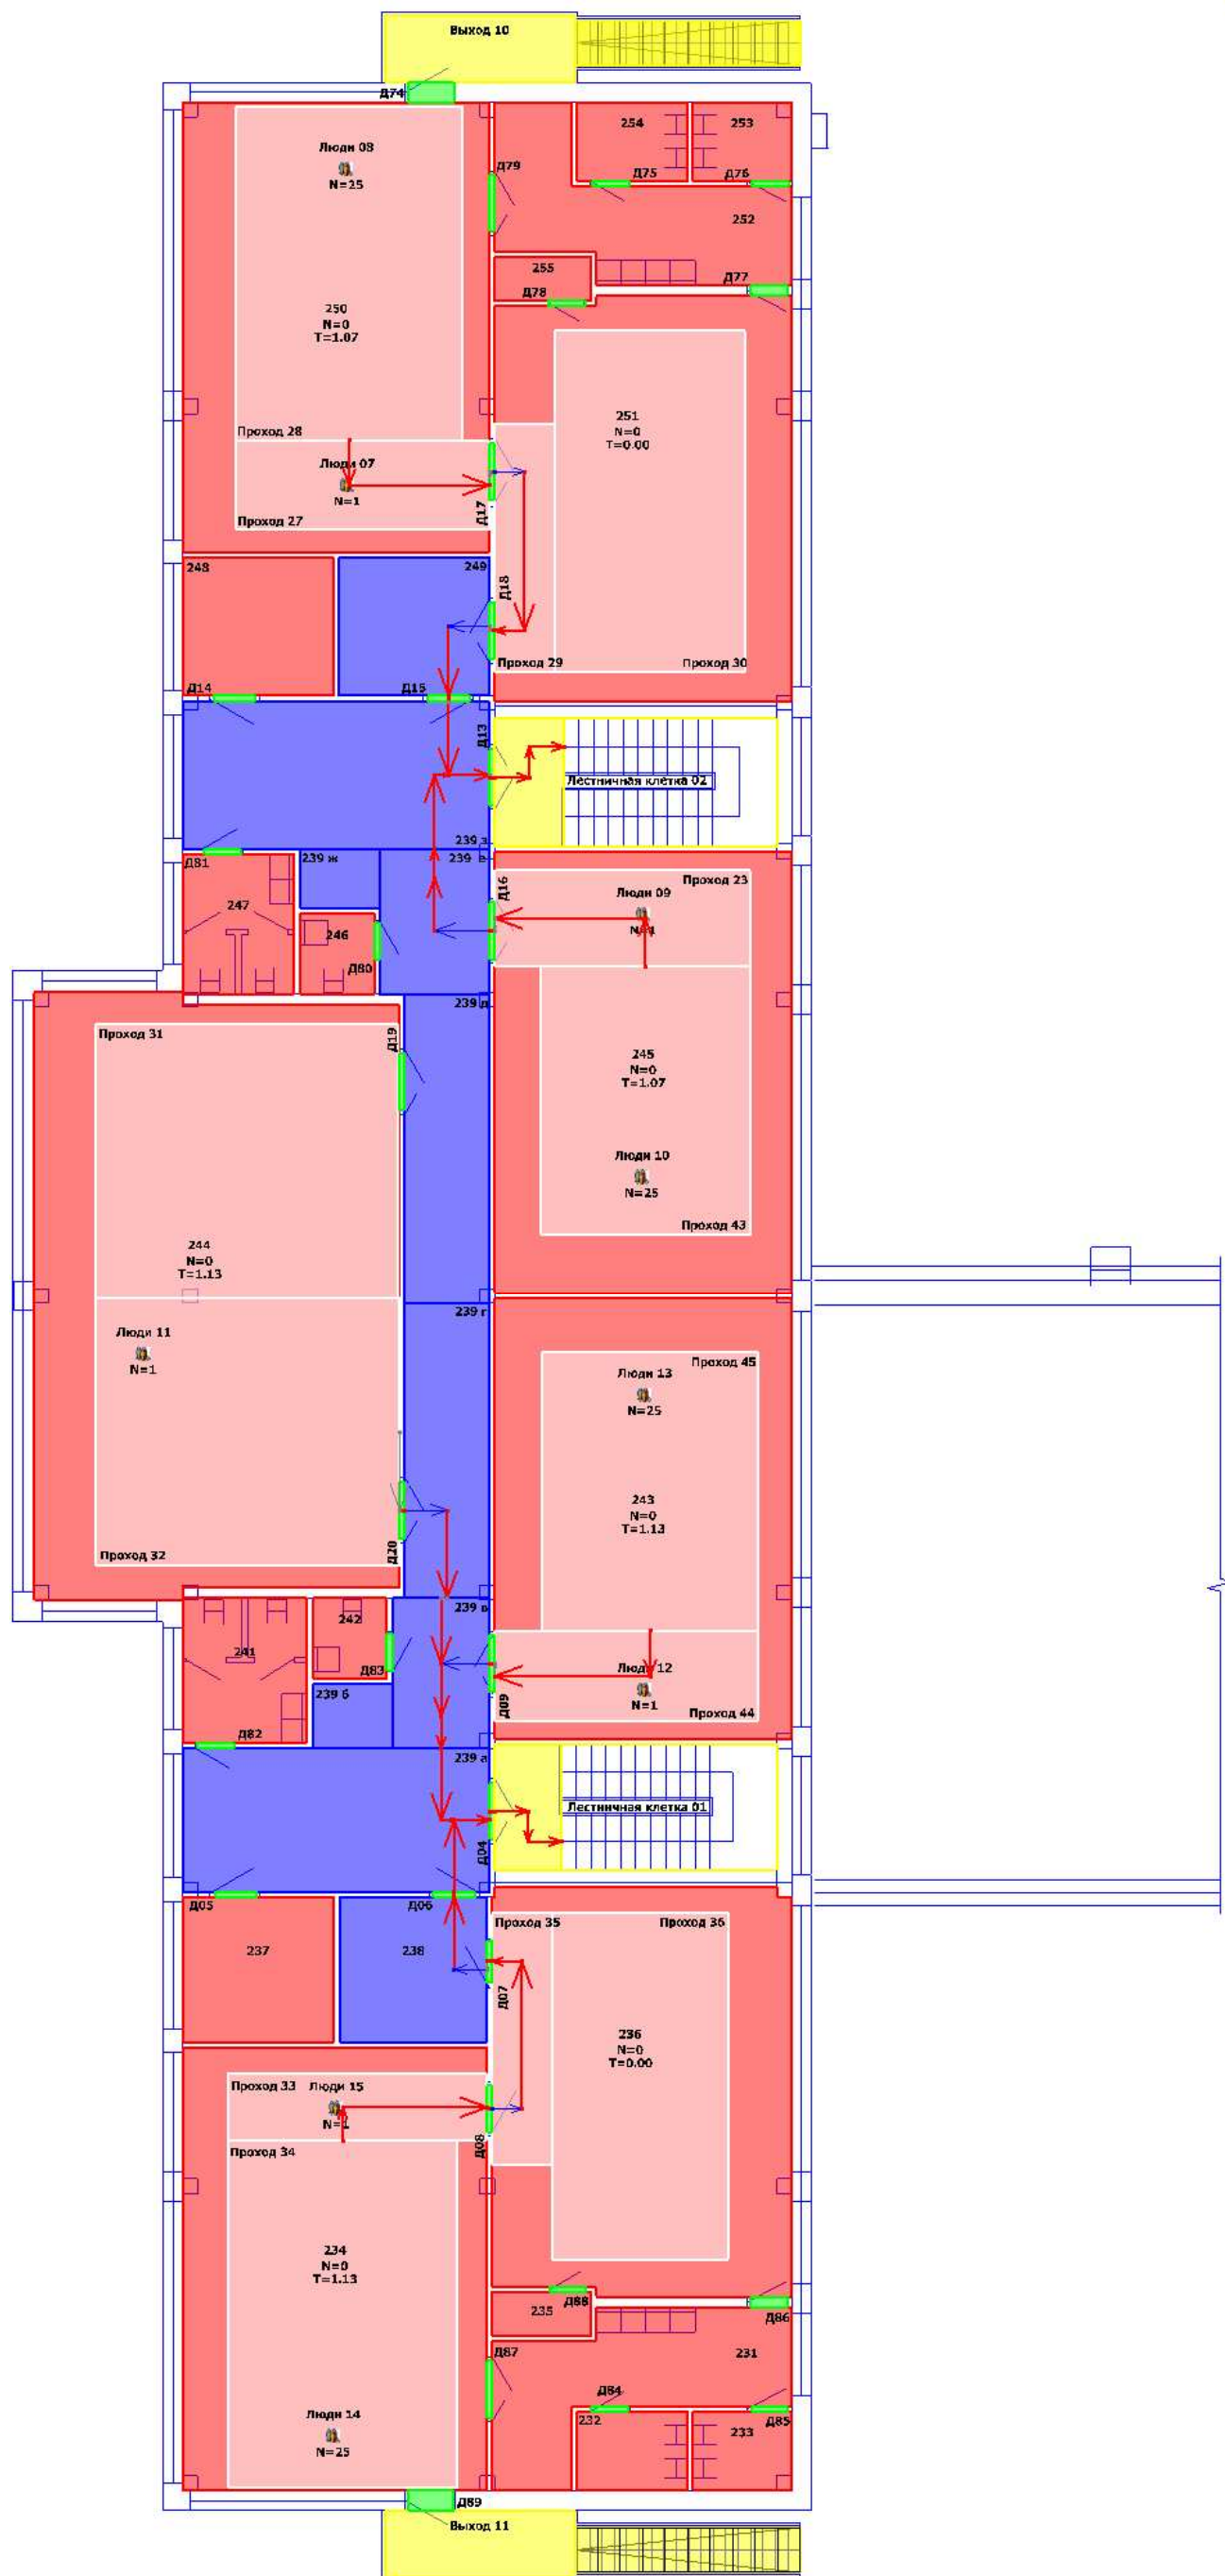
Расчетная схема эвакуации из помещений 2-го этажа здания Детского сада на 60 мест с начальной школой на 100 учащихся (Сценарий 01)
